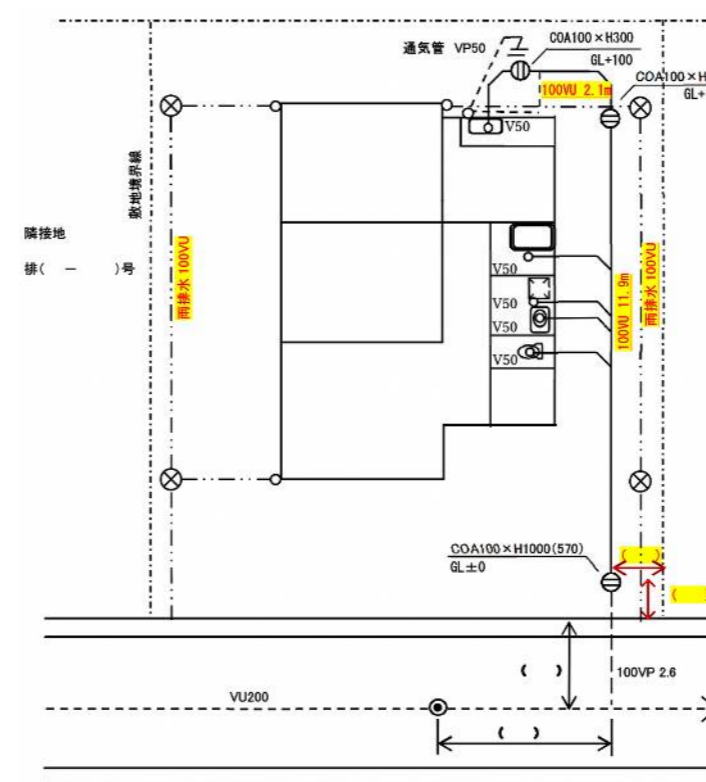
排水設備標準図 (例 1) 平面図縮尺 1/200
